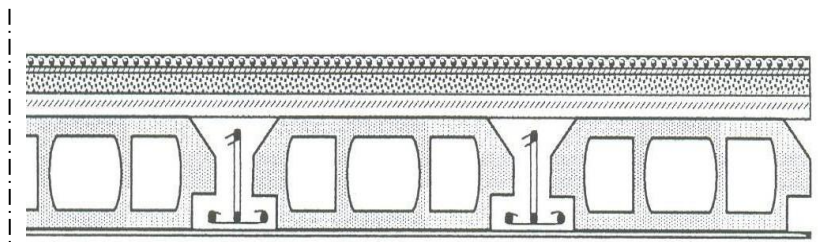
Détail des constituants de plancher terrasse inaccessible
